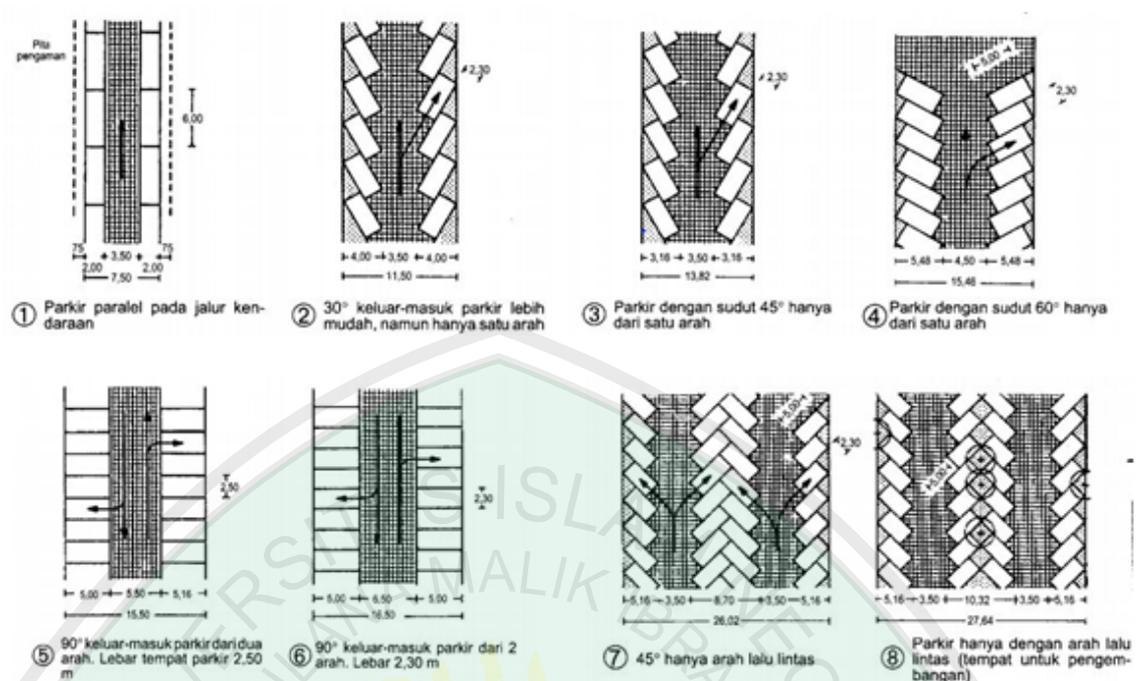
Standar Kebutuhan Ruang Parkir Truk
